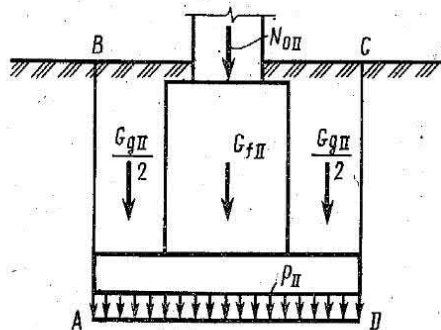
Расчетная схема центрально нагруженного фундамента
